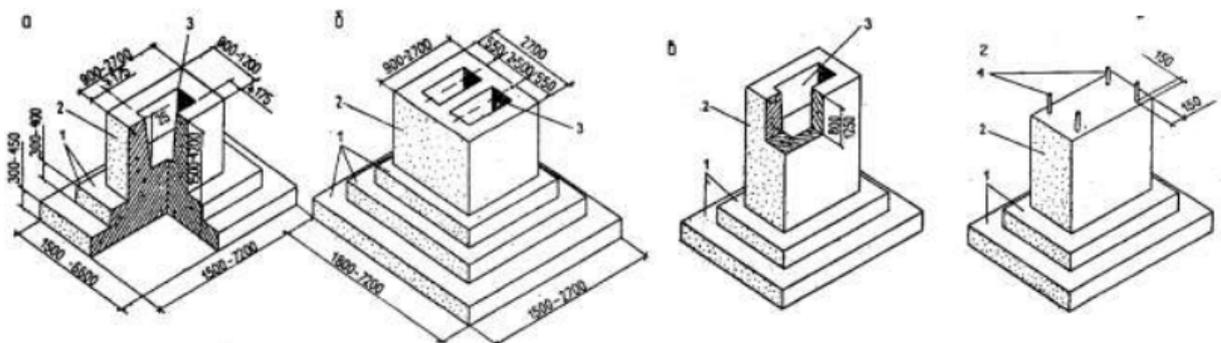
Монолітні залізобетонні фундаменти «стаканного» типу:
